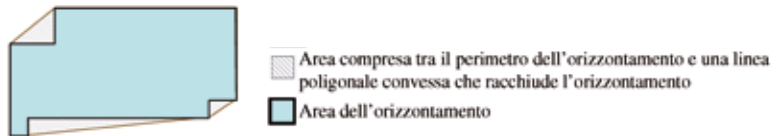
Esempio di verifica delle rientranze in pianta.
